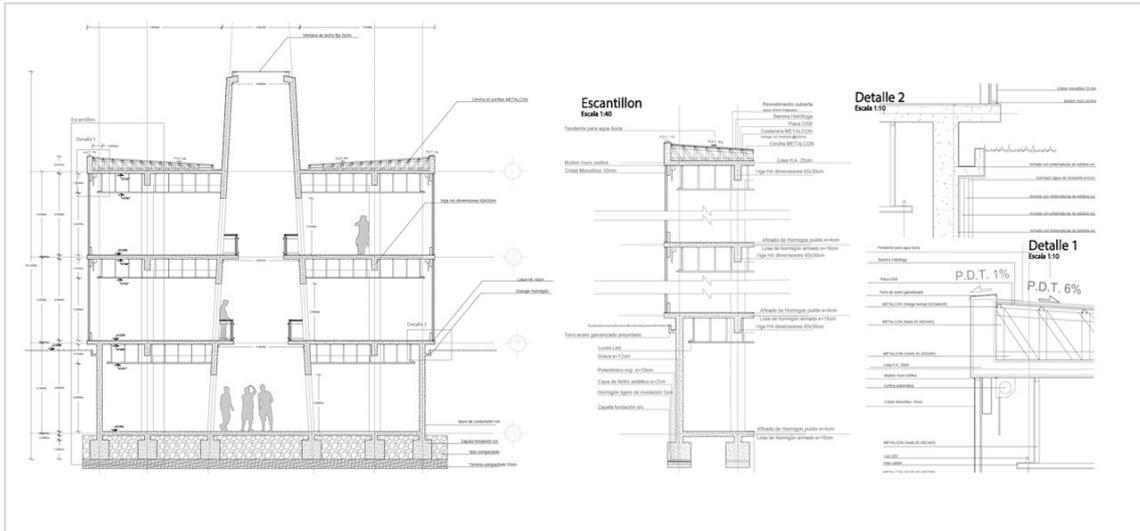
Desarrollo constructivo de proyecto. Fuente: Alan Suarez y Abigail Gutierrez. Sistemas Constructivos 1 (2023)
